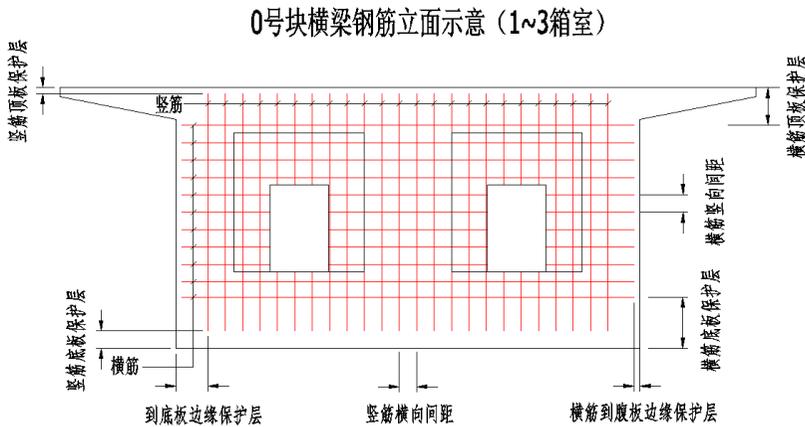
0号块-横梁钢筋网片立面示意图
